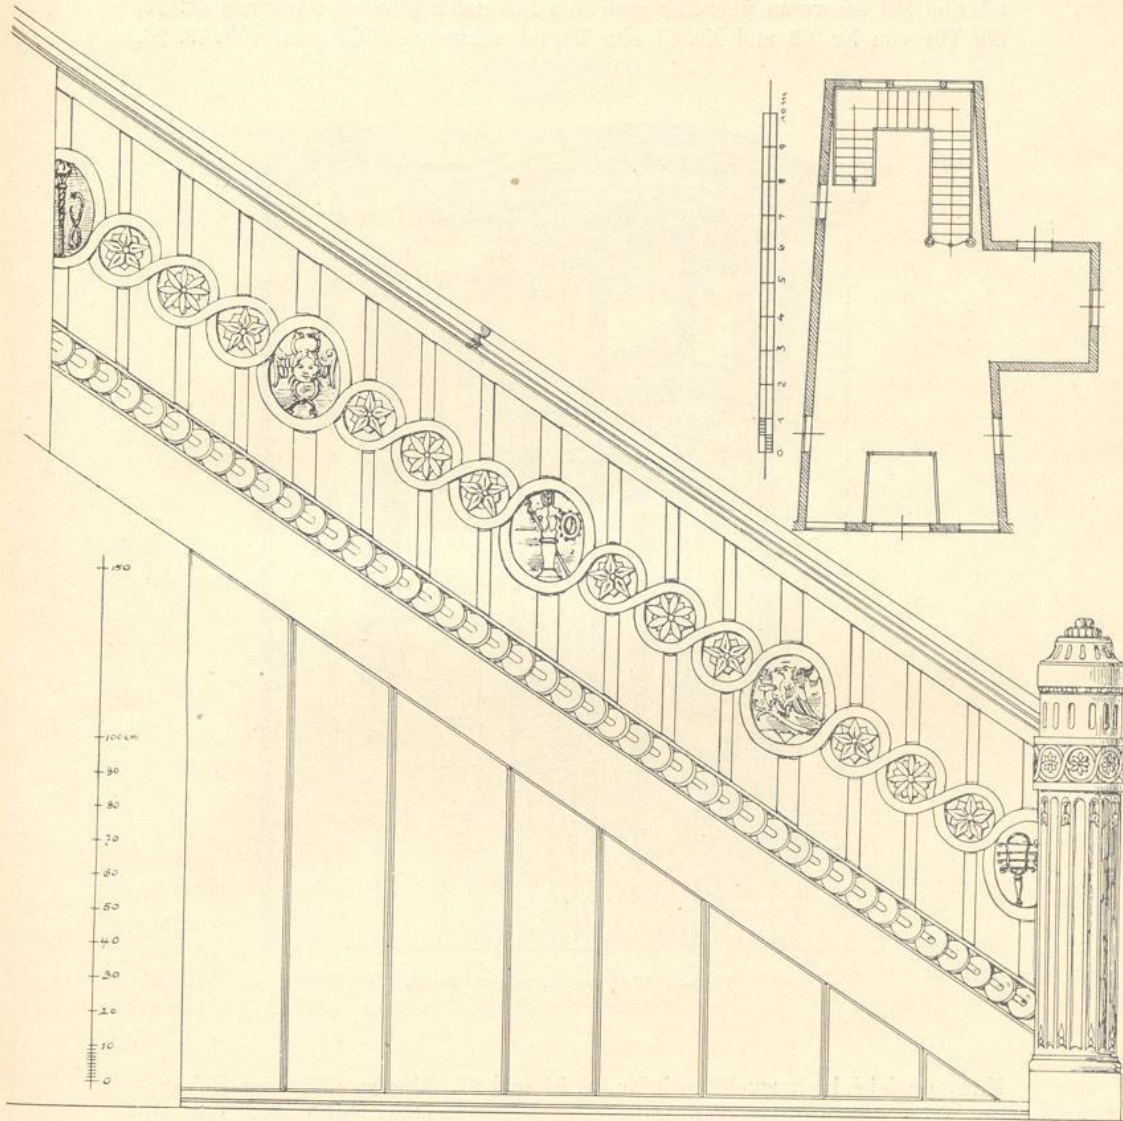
Wollenweberstraße 66. Diele. Grundriß. Treppe.
